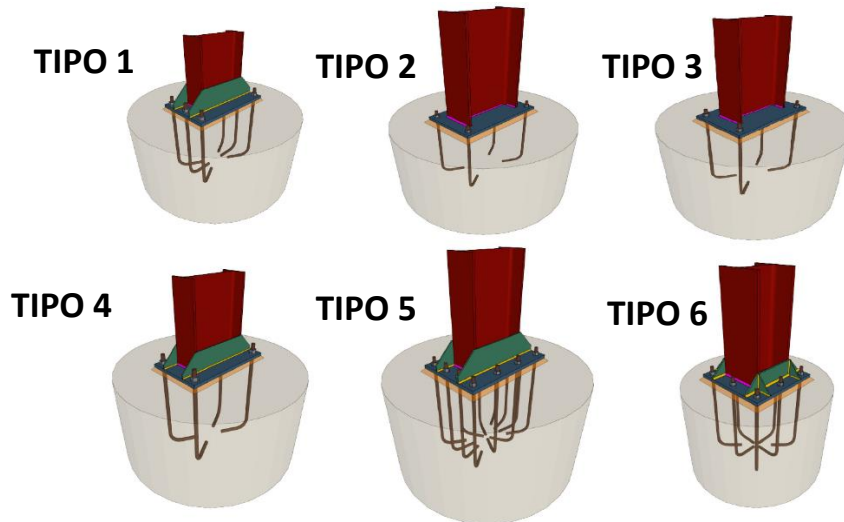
Vista 3D de las placas de anclaje. Fuente: CYPE 3D.
